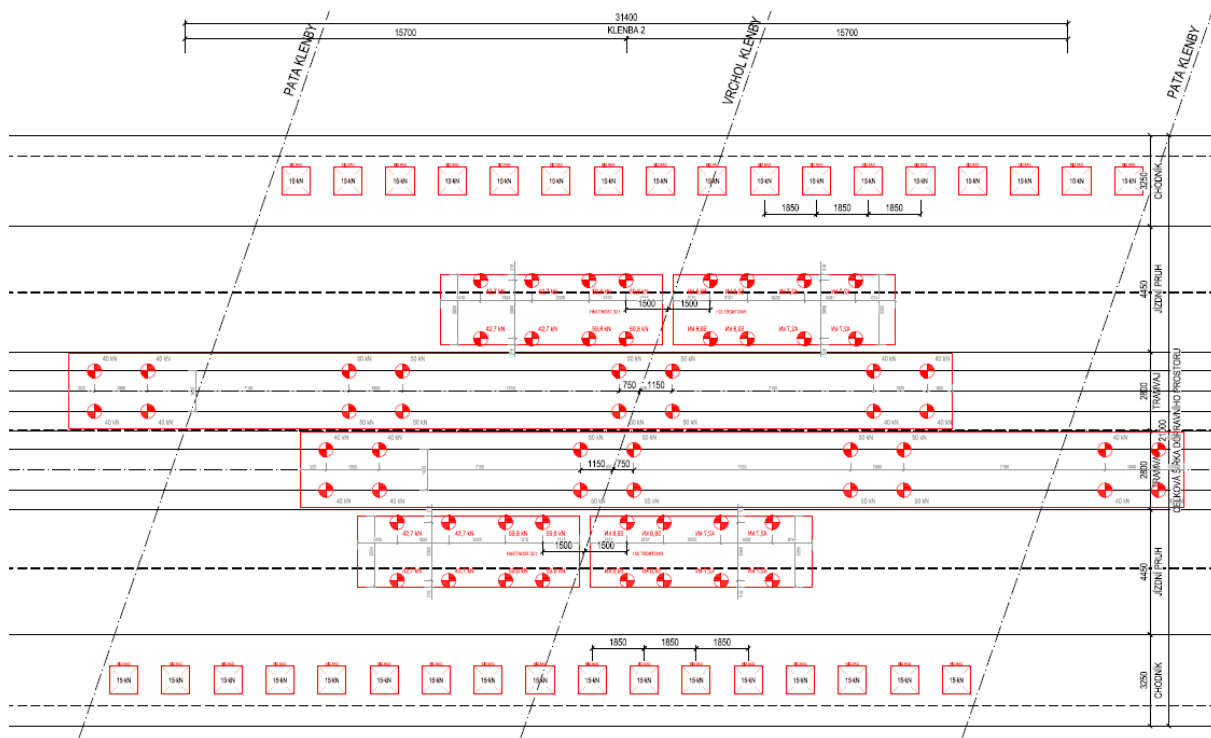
Schéma rozmístění zatížení ZS3 v půdorysu
